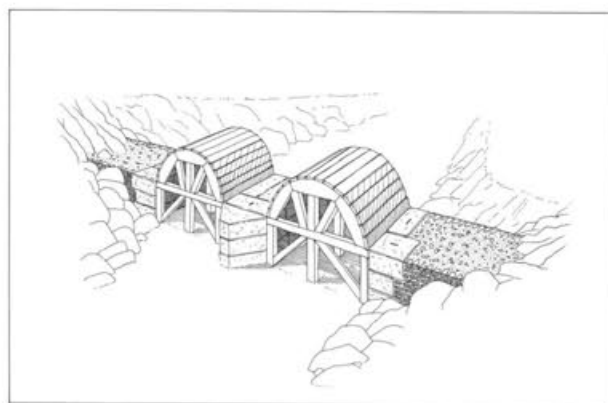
Augst/Kaiseraugst. Violebachbrücke. Rekonstruktionsversuch der Lehrgerüste.
